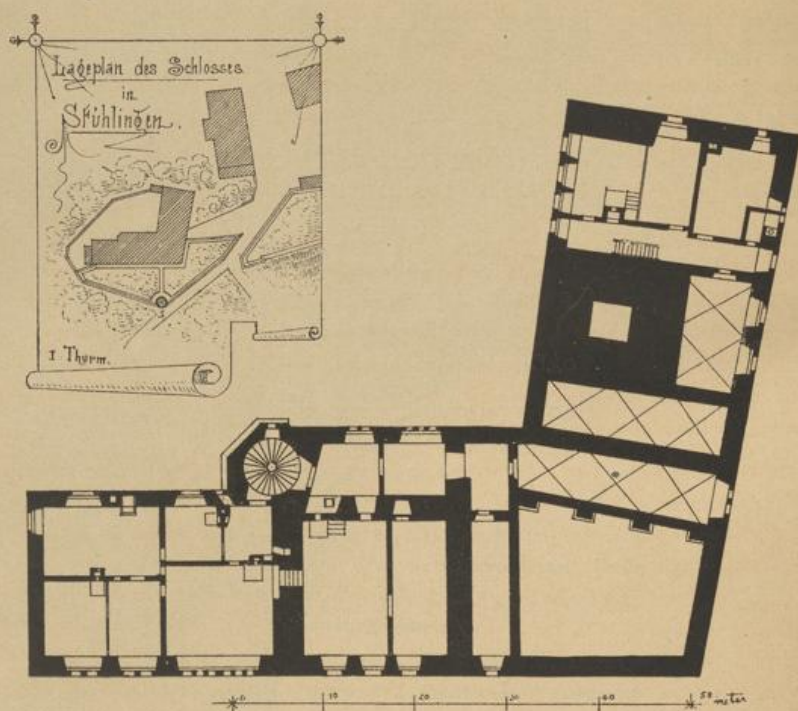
Stühlingen. Grund- und Lageplan des Schlosses.
